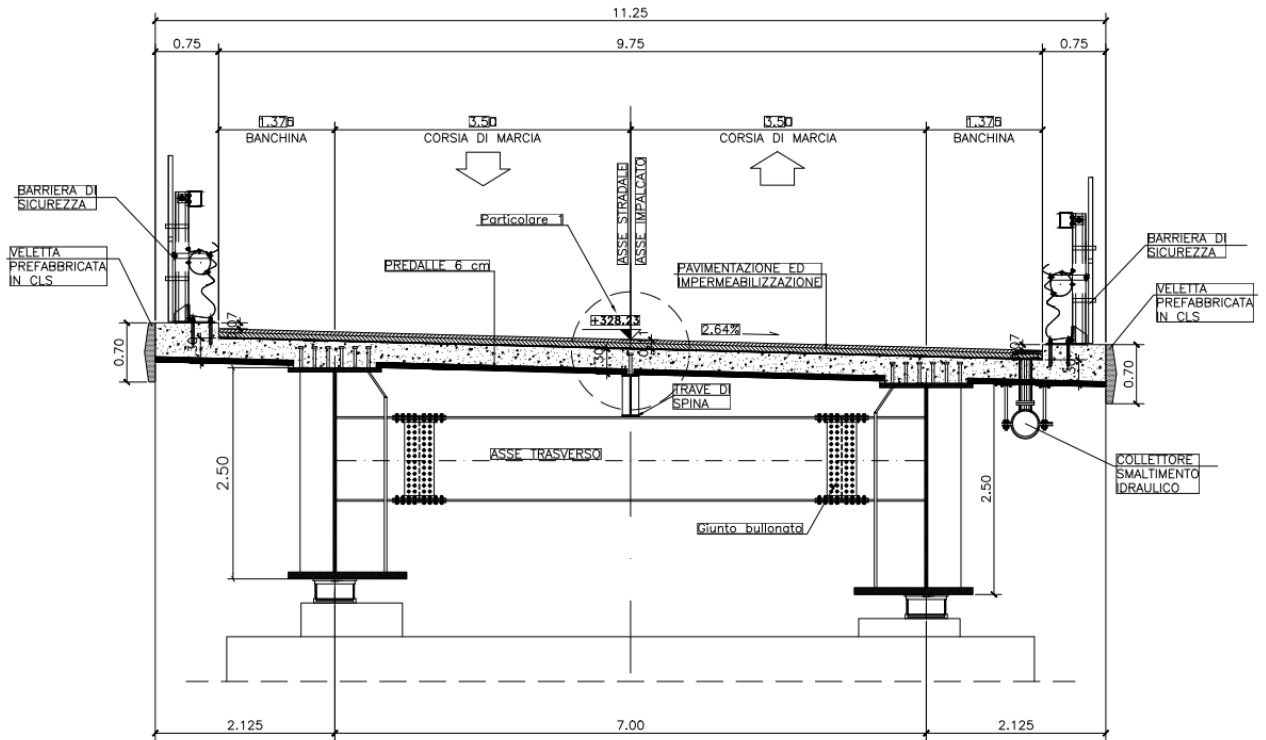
Sezione trasversale dell'impalcato - sezione tipo su spalla S1
